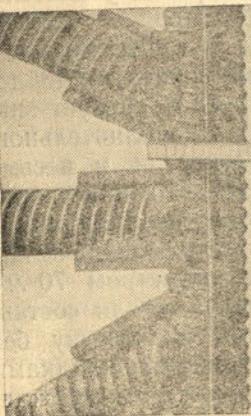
Узел арматурных конструкций, сваренный ванным способом
